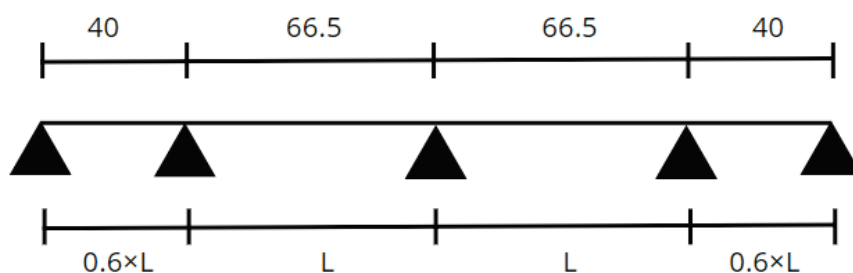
Coupe longitudinale de la 1^{ère} variante
